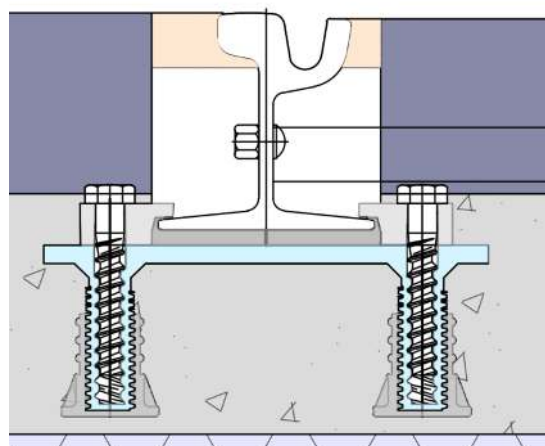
Detalle de la fijación del carril. Extraído del plano 2.9.3.
